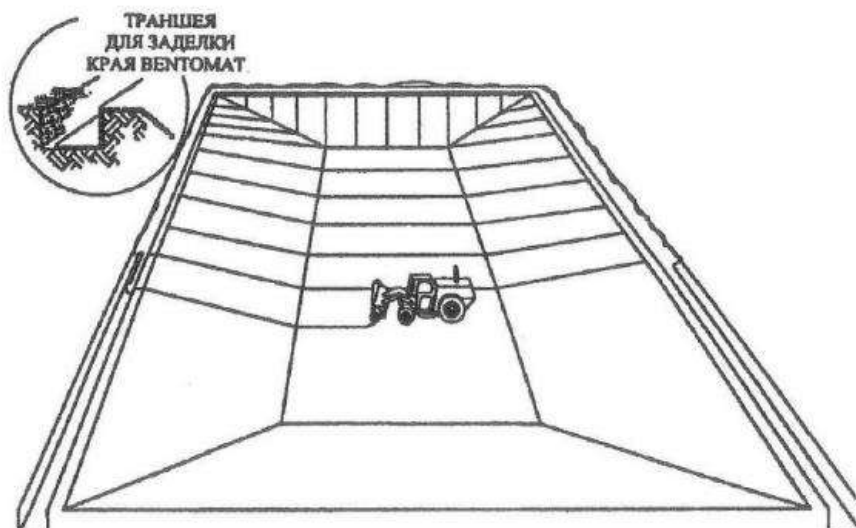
Схема укладки BENTOMAT
